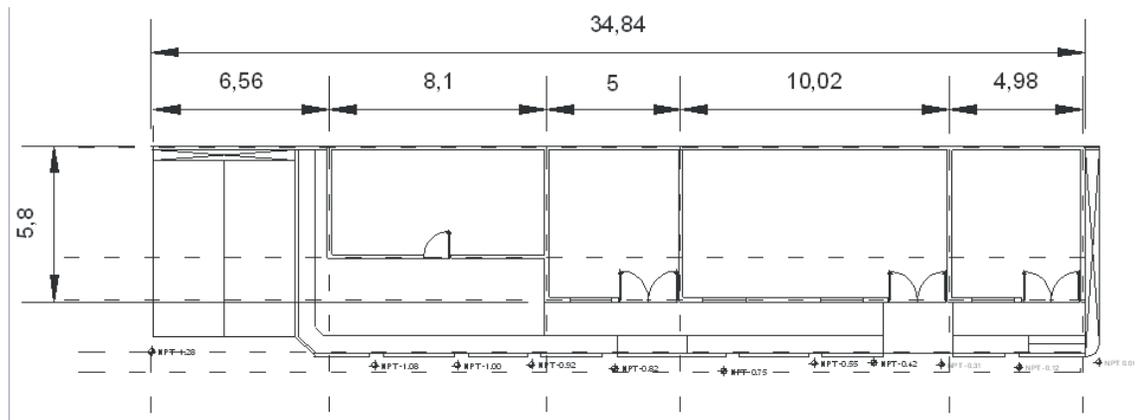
Levantamiento del área designada para realizar la distribución de planta de los talleres de carpintería, herrería y maquetas.
